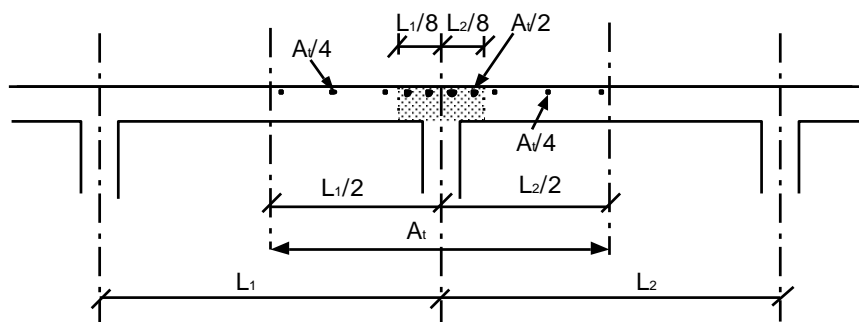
Planchers-dalles – Concentration des armatures de chapeaux
